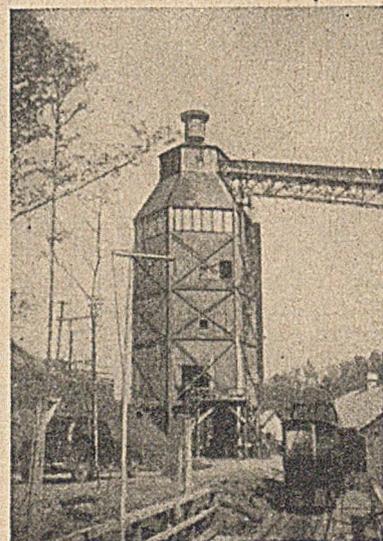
Betonier-Anlage (Hiwassee-Staumauer).
